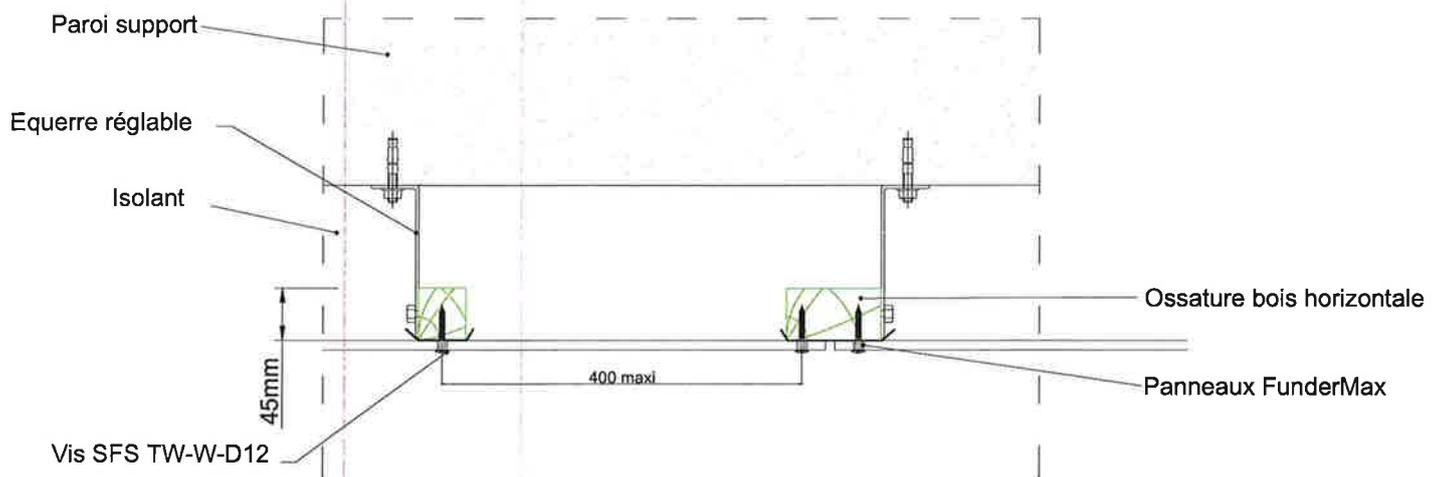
Pose en sous-face – Coupe verticale sans isolant
